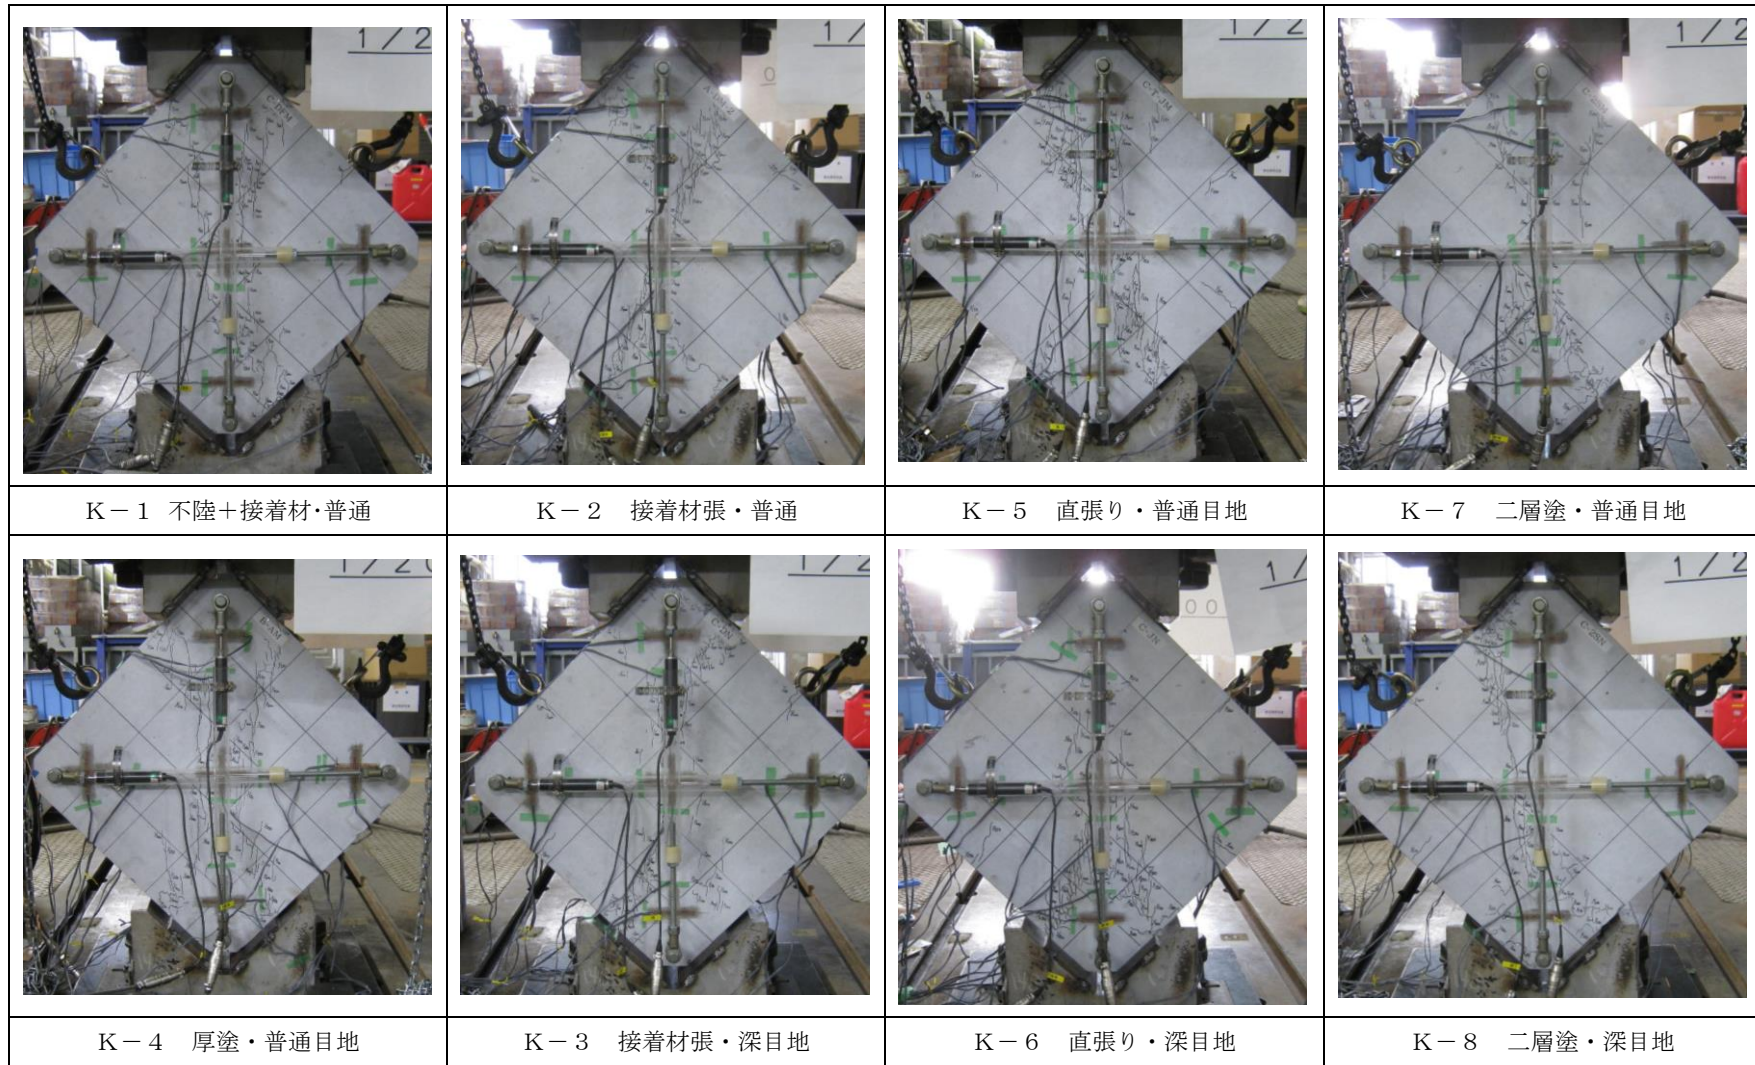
セン断変形角 1/200 時の解放型治具によるダイアゴナル試験のコンクリート基盤の破壊状況
